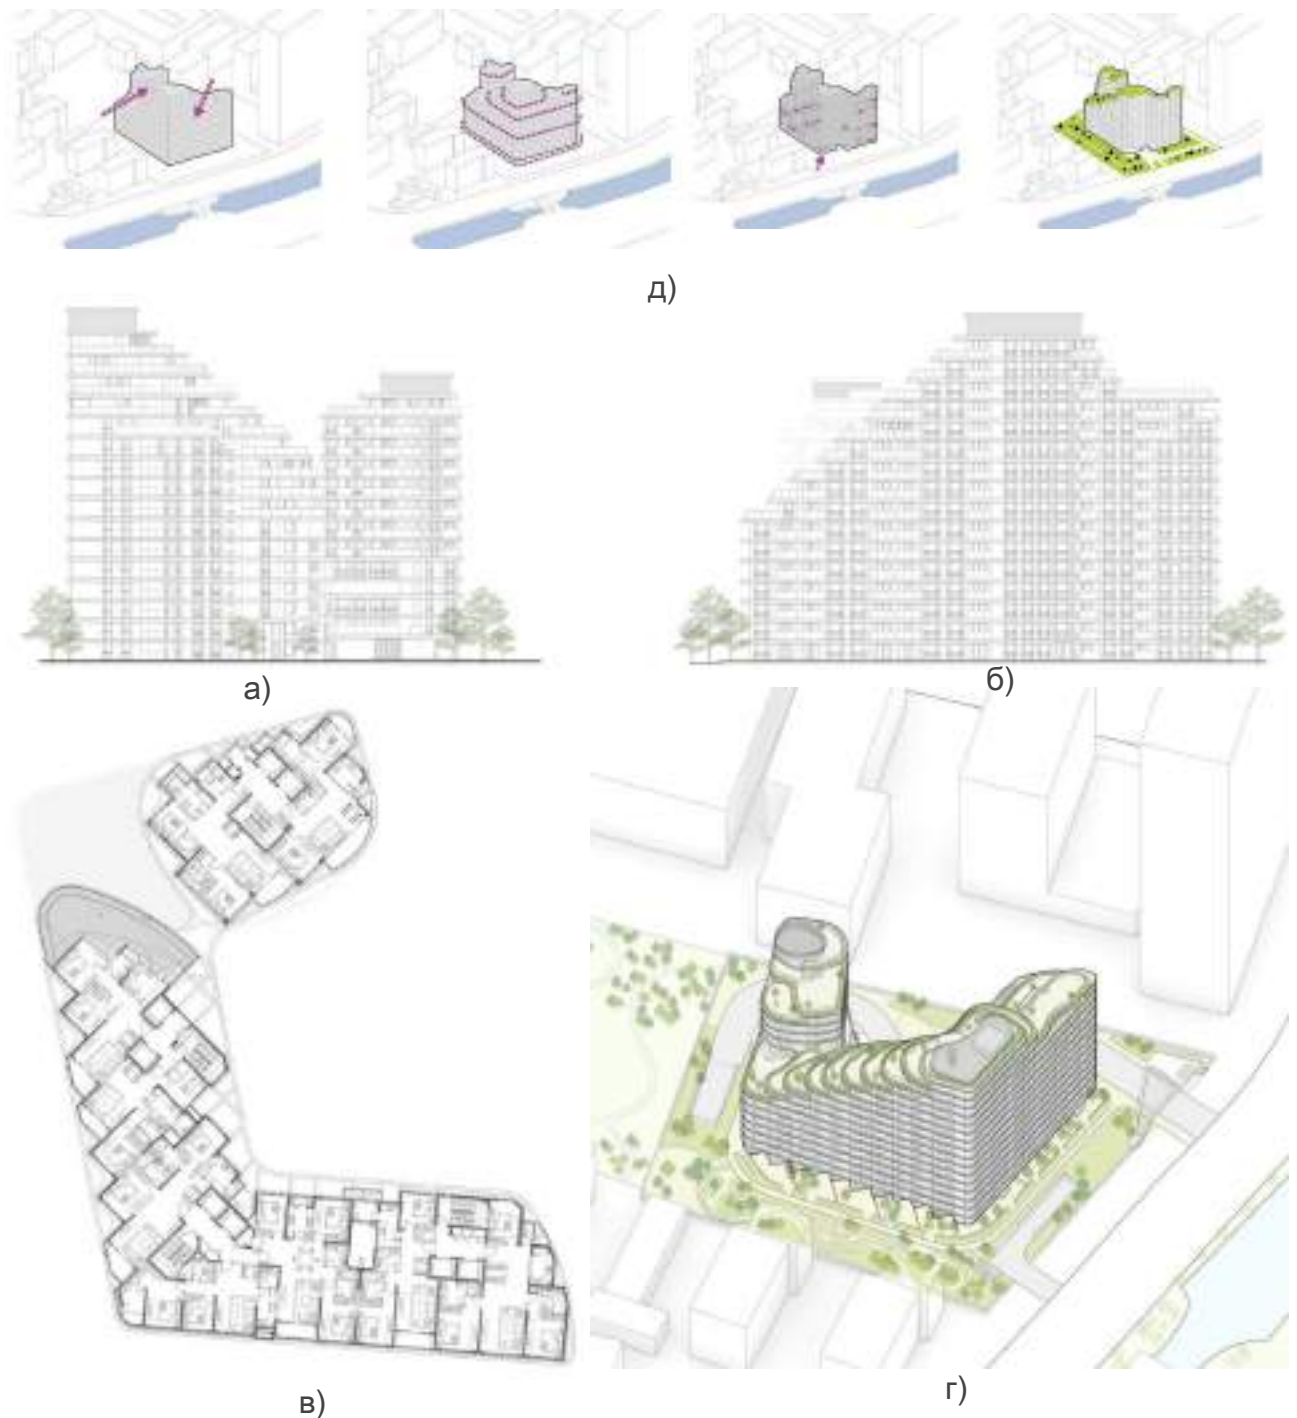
K. Wah Riverside E18, м.Шанхай (Китай). Aedas , EID Arch , Shanghai Tianhua Architectural Design 2023 а. Південний фасад б. Західний фасад в. План типового поверху г. Схема озеленення д. Діаграми [37].
